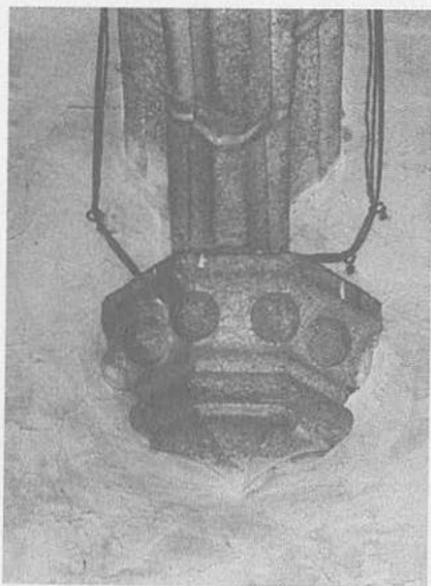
Claustro de los Reyes. Panda este. Corredor superior. Muro este-lado oeste. Ménsula.
